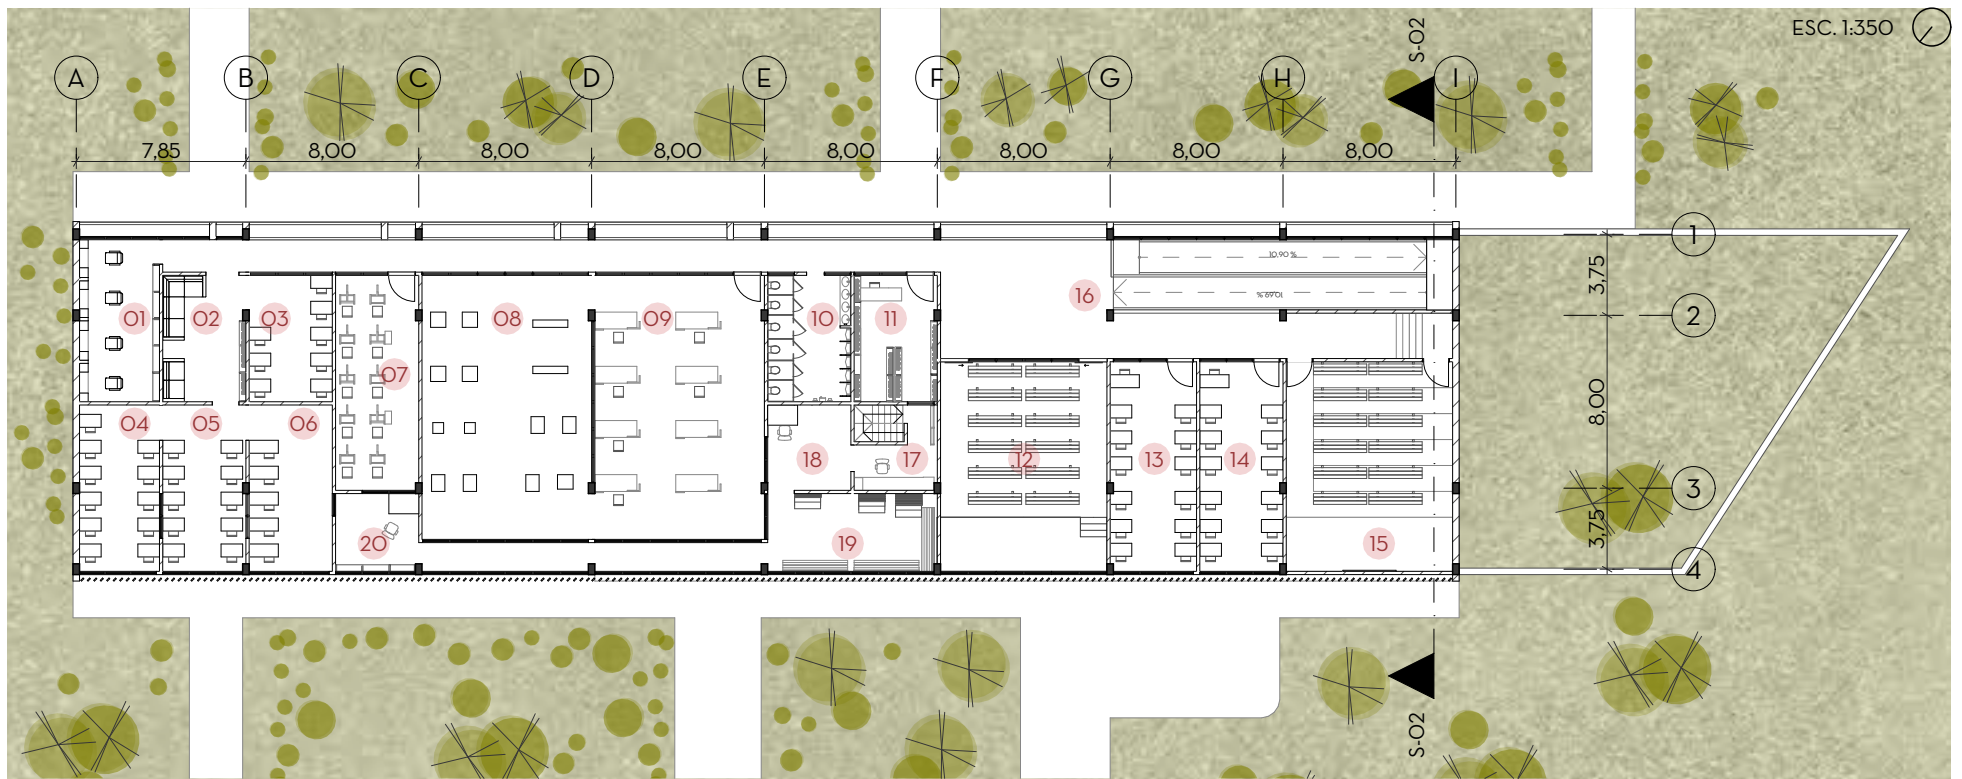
Planta alta edificio de actividades. Fuente: Autoría propia
